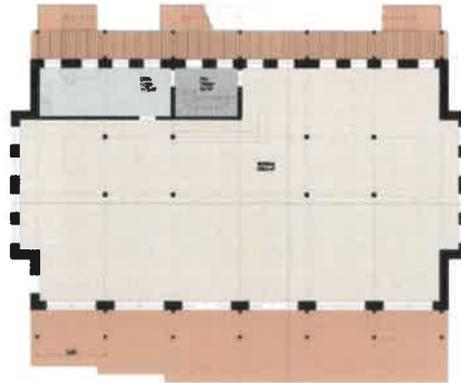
Grundrisse und Dachaufsicht Shopgebäude Bretterbude
